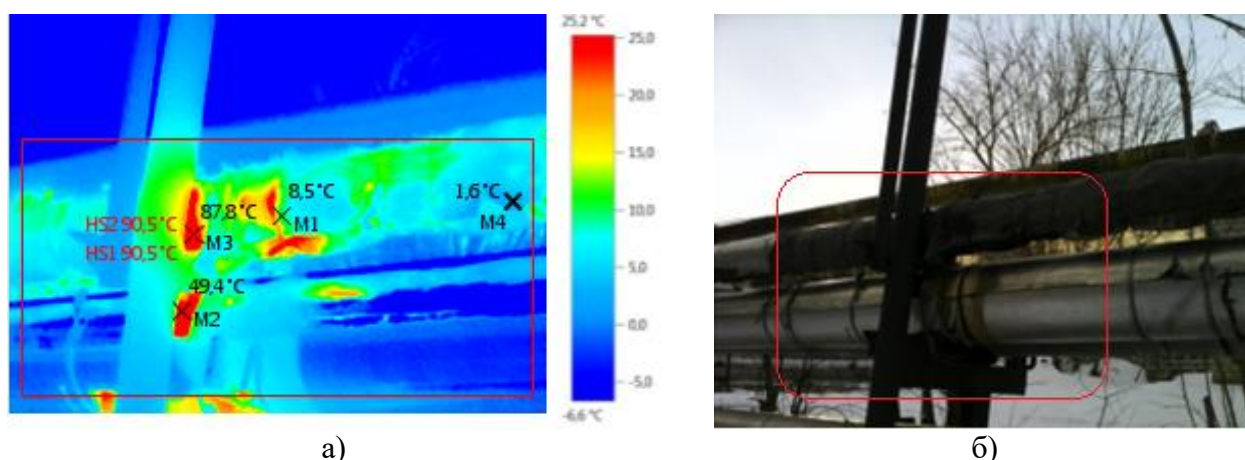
Обследование опор наземных трубопроводов, тепловизором Testo 868 при наружной температуре +1 °С
